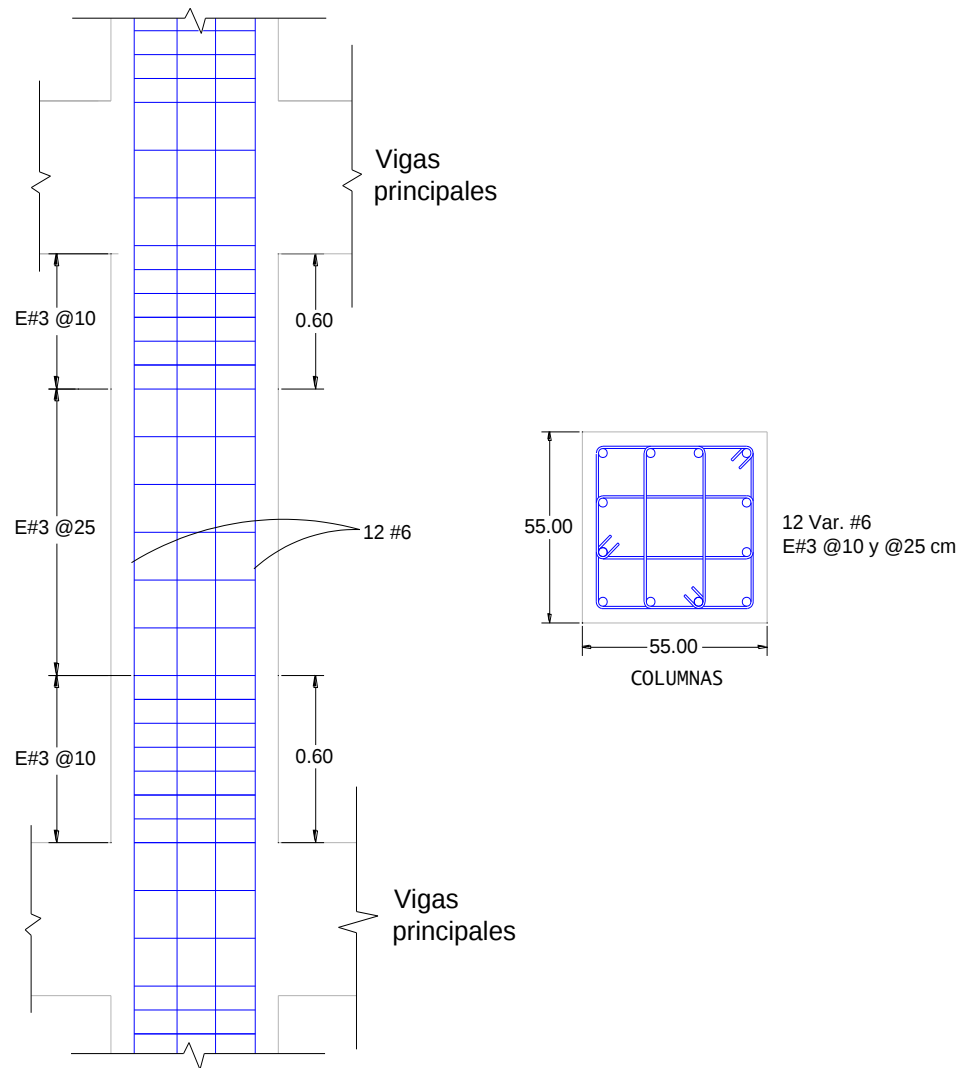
Armado y detallado de las columnas del edificio en estudio, de acuerdo con la NTC-Concreto-2004.
